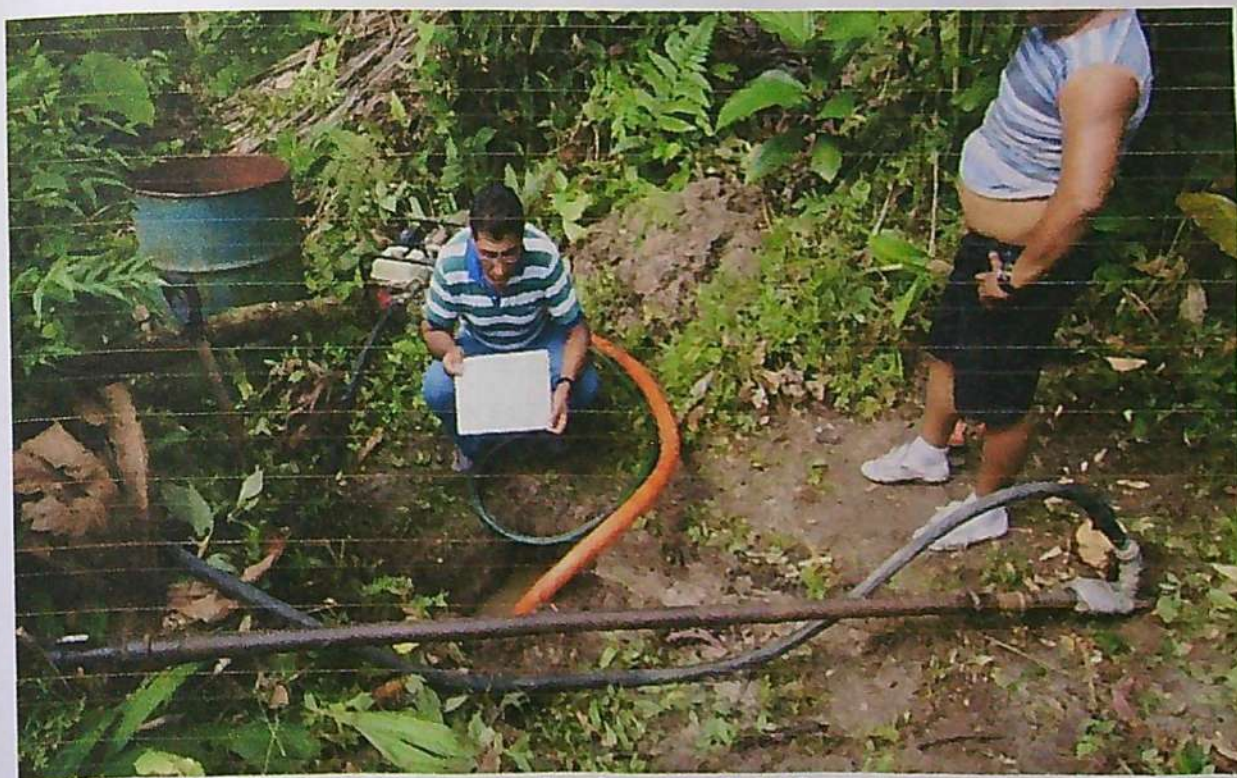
Perforación N° 01, se verifica la colocación de las herramientas y equipos para la perforación.
